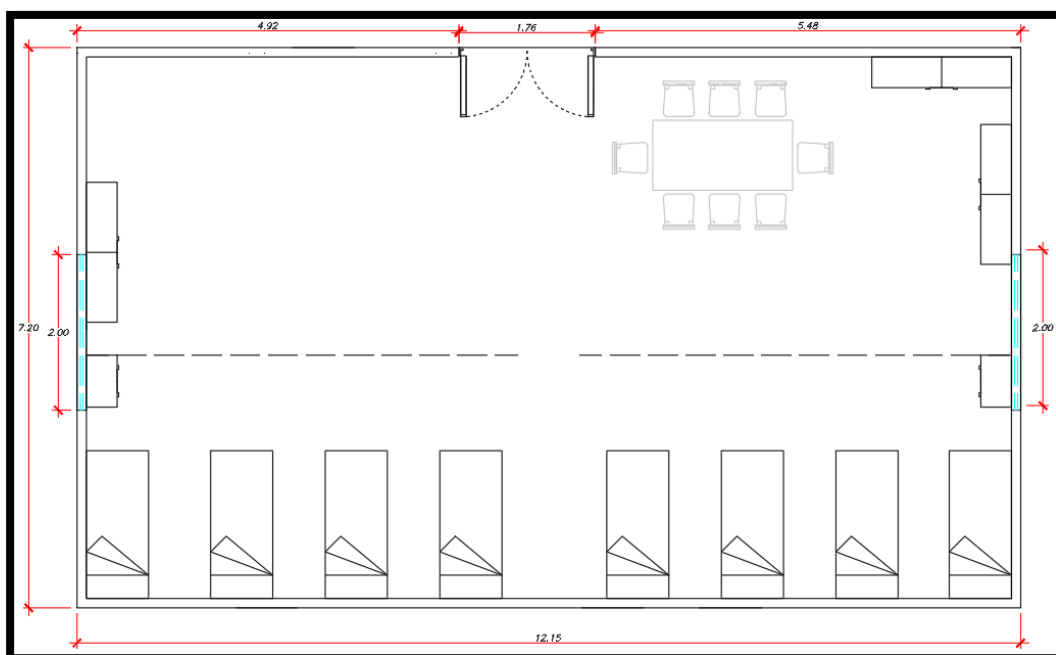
Distribución Módulo Temporal Tipo "C"- Vista Planta
